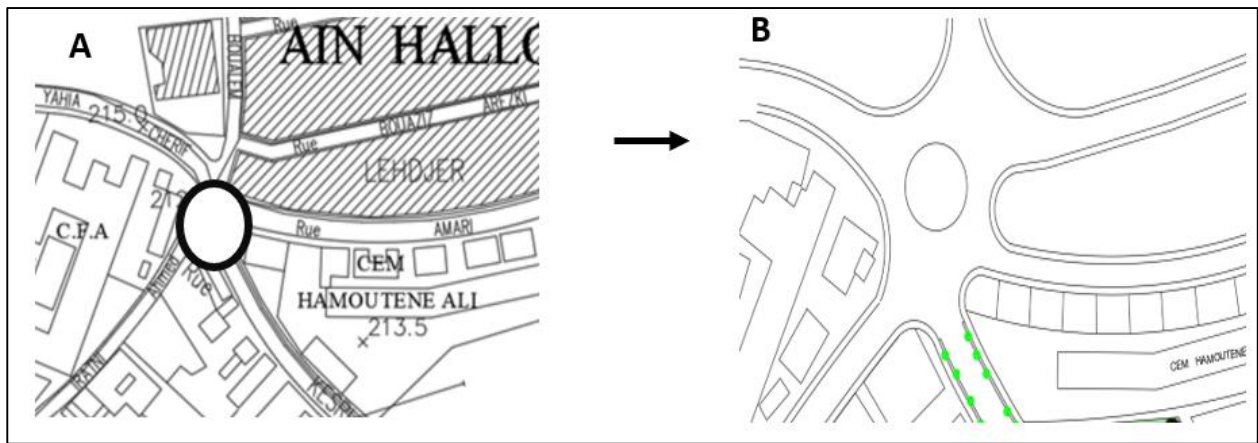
50: Vue en plan de l'intersection avant et après intervention.
